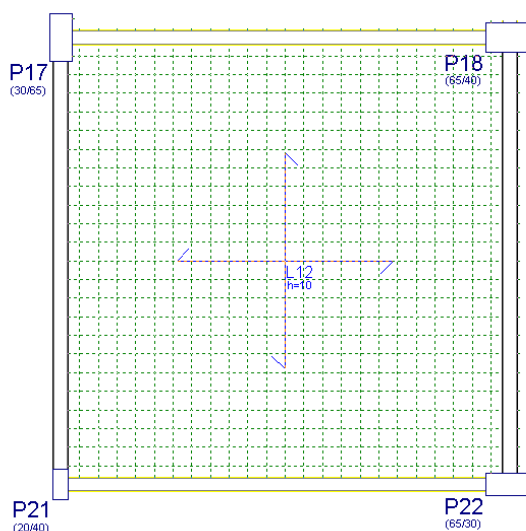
Discretização da Laje L12- CYPECAD 2008 [5]
